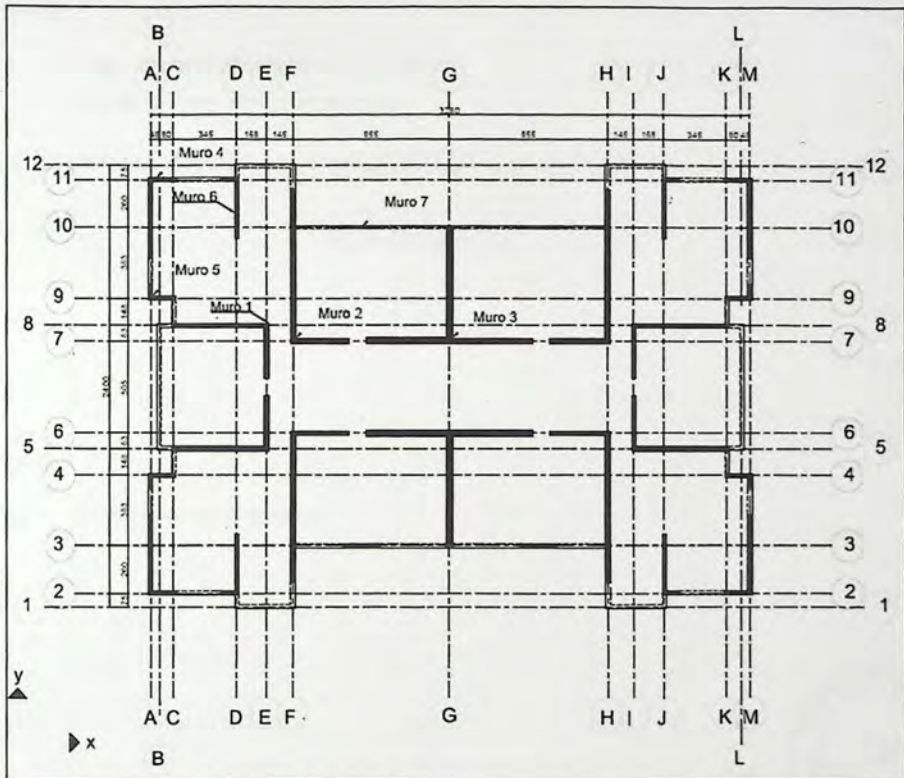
Planta de estructuras- Numeración de los muros estructurales
